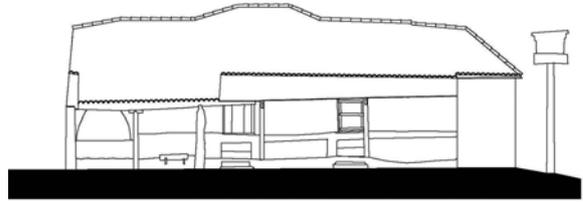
Fachada Posterior (Acervo PROAU/FAU/UnB).
